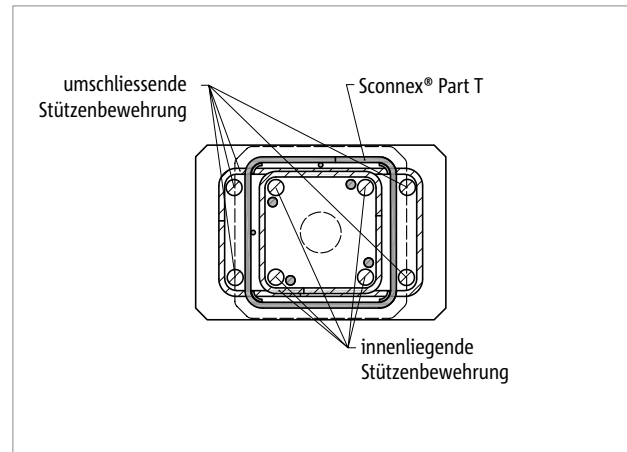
Schöck Sconnex® Typ P: Bewehrungsführung im Bereich 3 – Stützenquerschnitt
